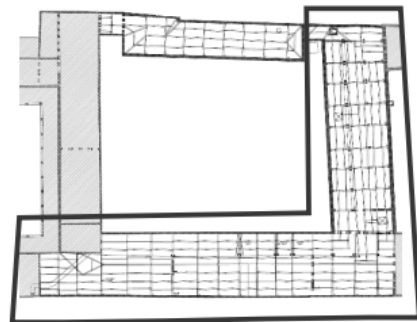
inquadramento in pianta della porzione di sottotetto indagata (Zona F in basso e Zona G a destra)
